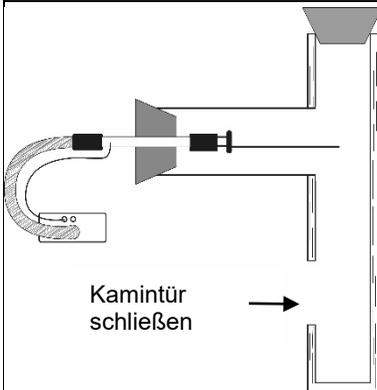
Testaufbau durch das Ofenanschlussstück mit gerader Muffe.
